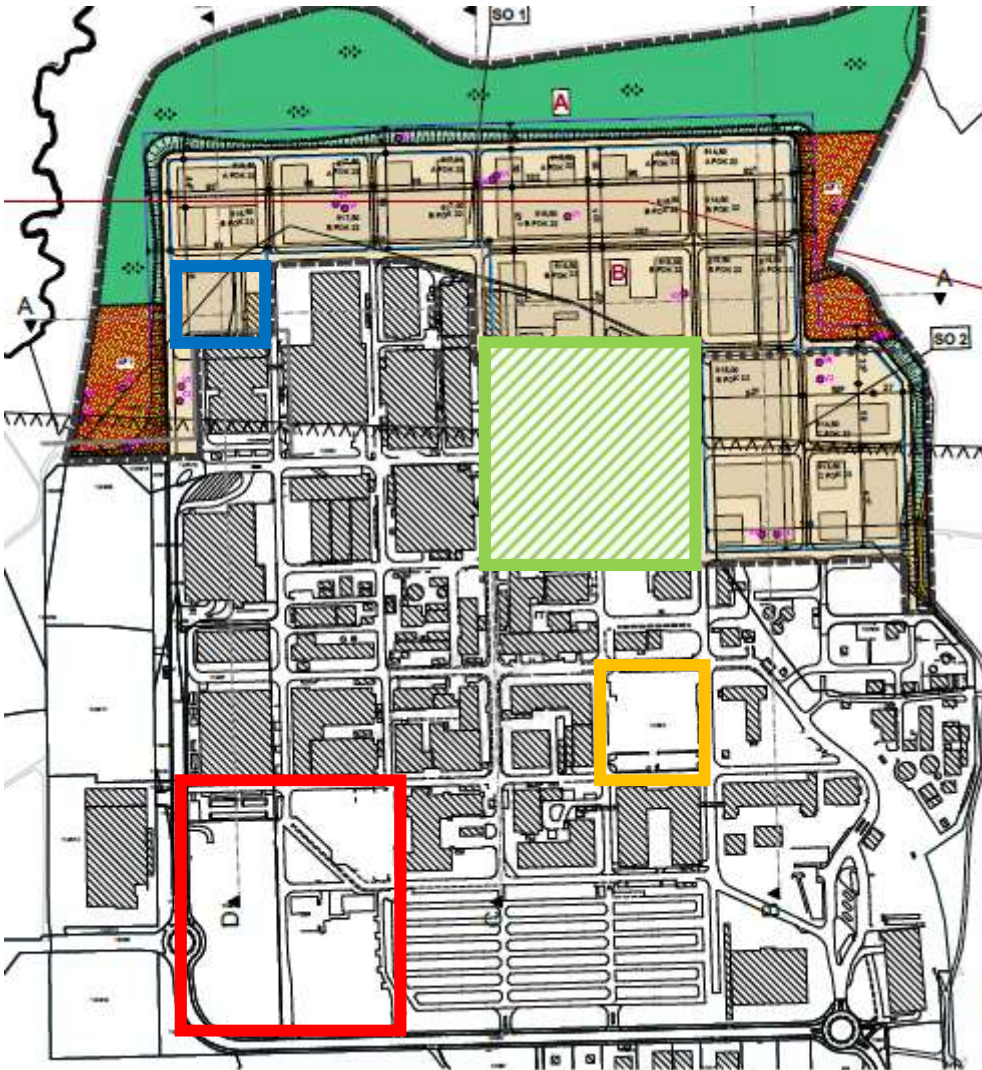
Geplanter Bebauungsplan: Verdichtungspotential auf dem bestehenden Werksgelände; rote und gelbe Umrandung = bebaubare Flächen (Freiflächen bzw. mit temporärer Nutzung). Grün schraffierte Fläche: Raster mit überwiegend niedriger Bebauung, die man durch höhere Bebauung ersetzen sollte. Blaue Fläche: mögliche Erweiterung des Werksgeländes.
